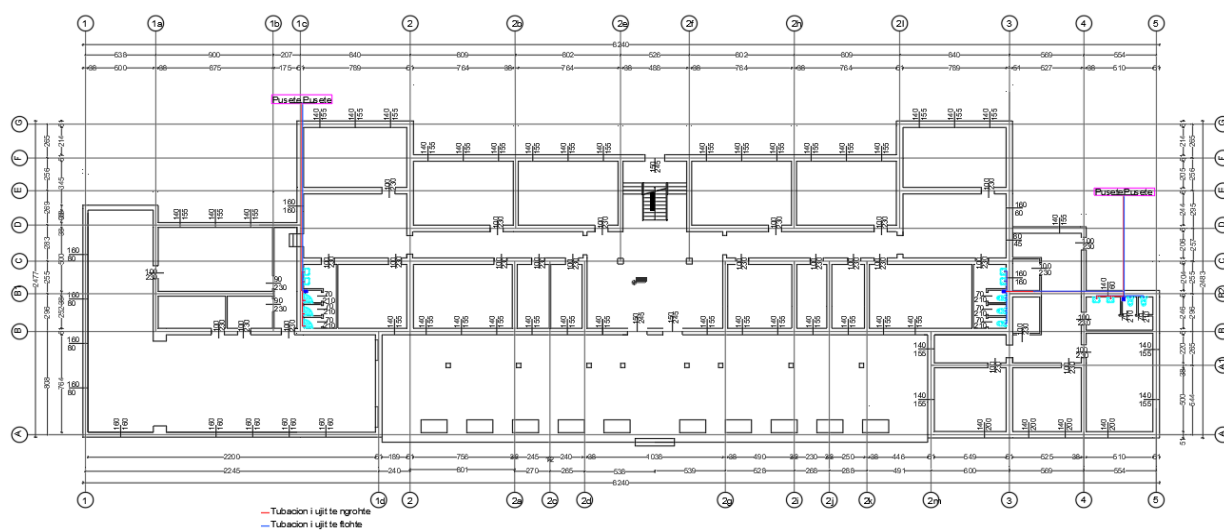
Planimetria e instalimeve hidraulike, kati perdhe
